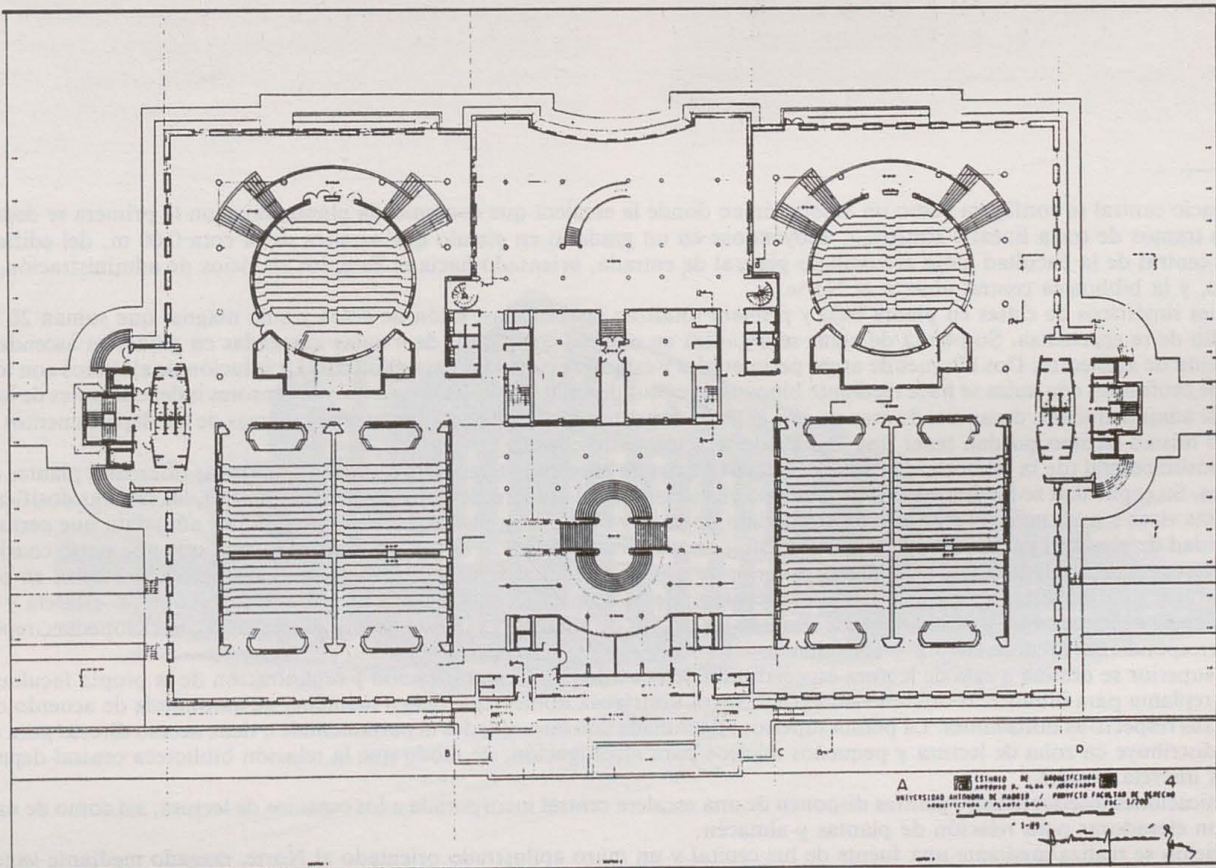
Antonio Fernández Alba: Proyecto de Facultad de Derecho. Planta baja. Escala 1/200.
